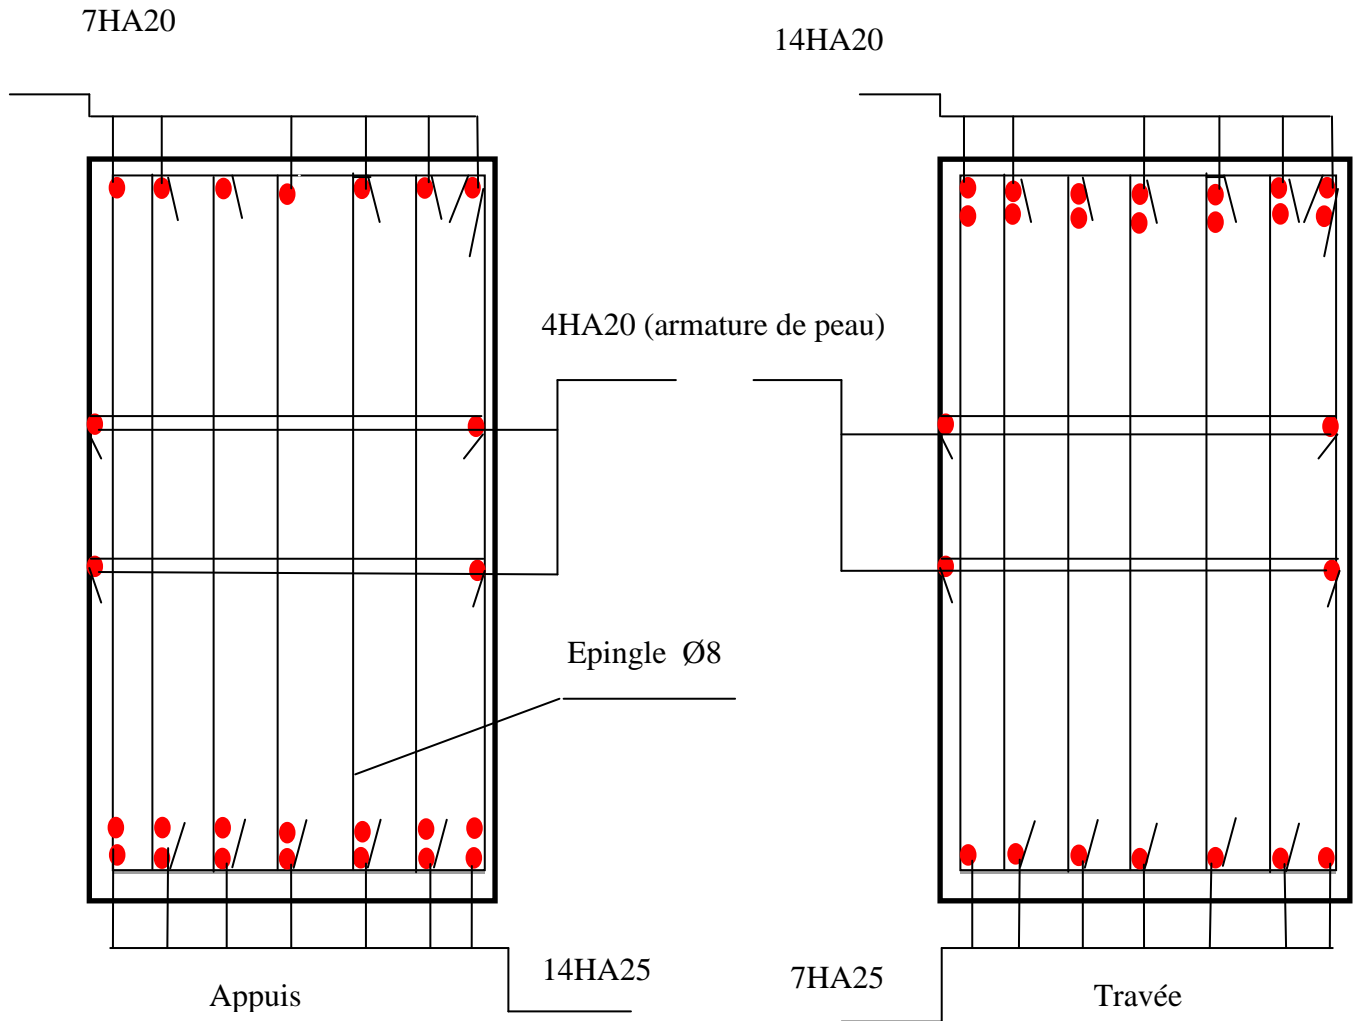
schéma de ferrailage des nervures sens Y-Y
